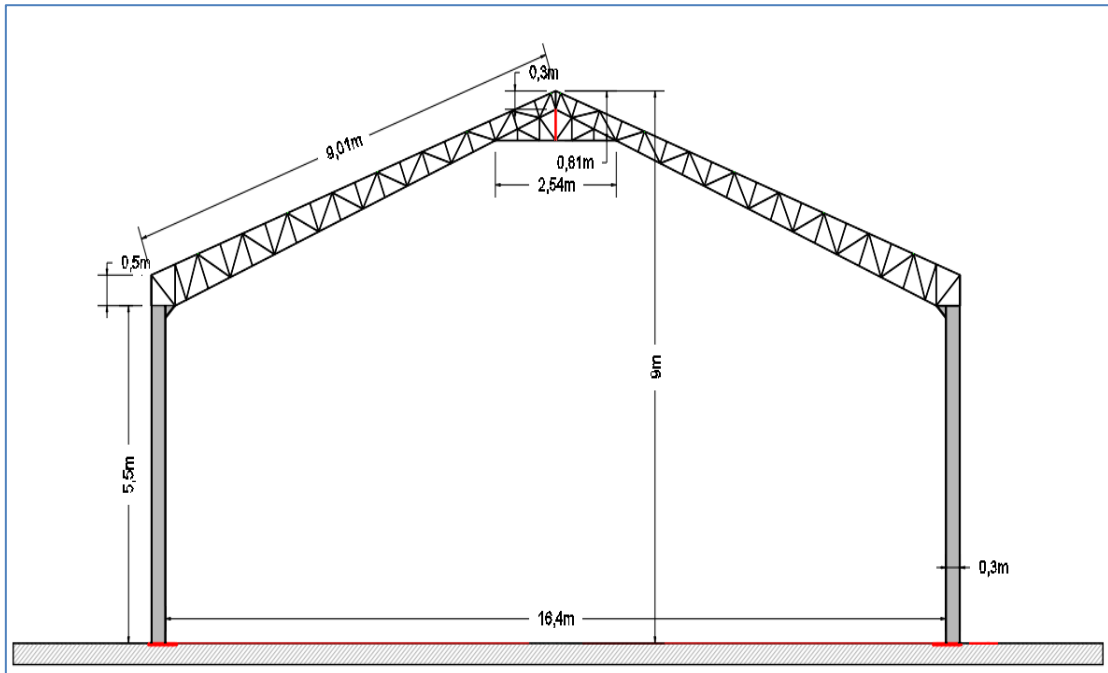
Geometría de la Cercha (Alternativa 2) – Vista Frontal
